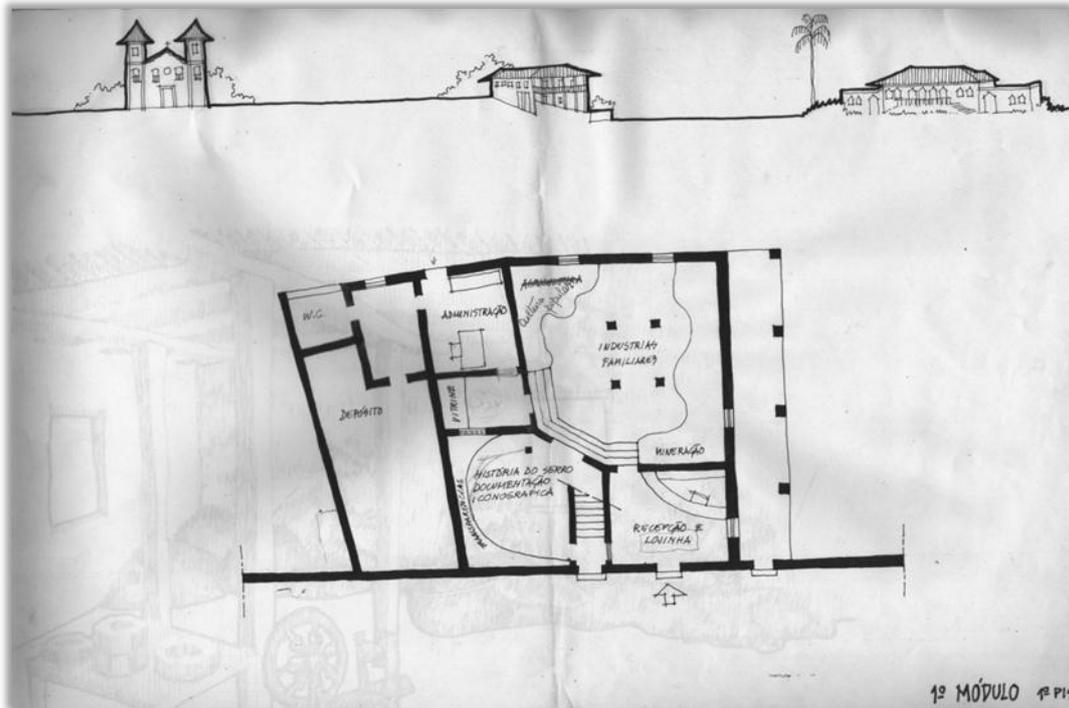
Prancha 3 – primeiro módulo, planta do 1º piso da Casa dos Ottoni.
